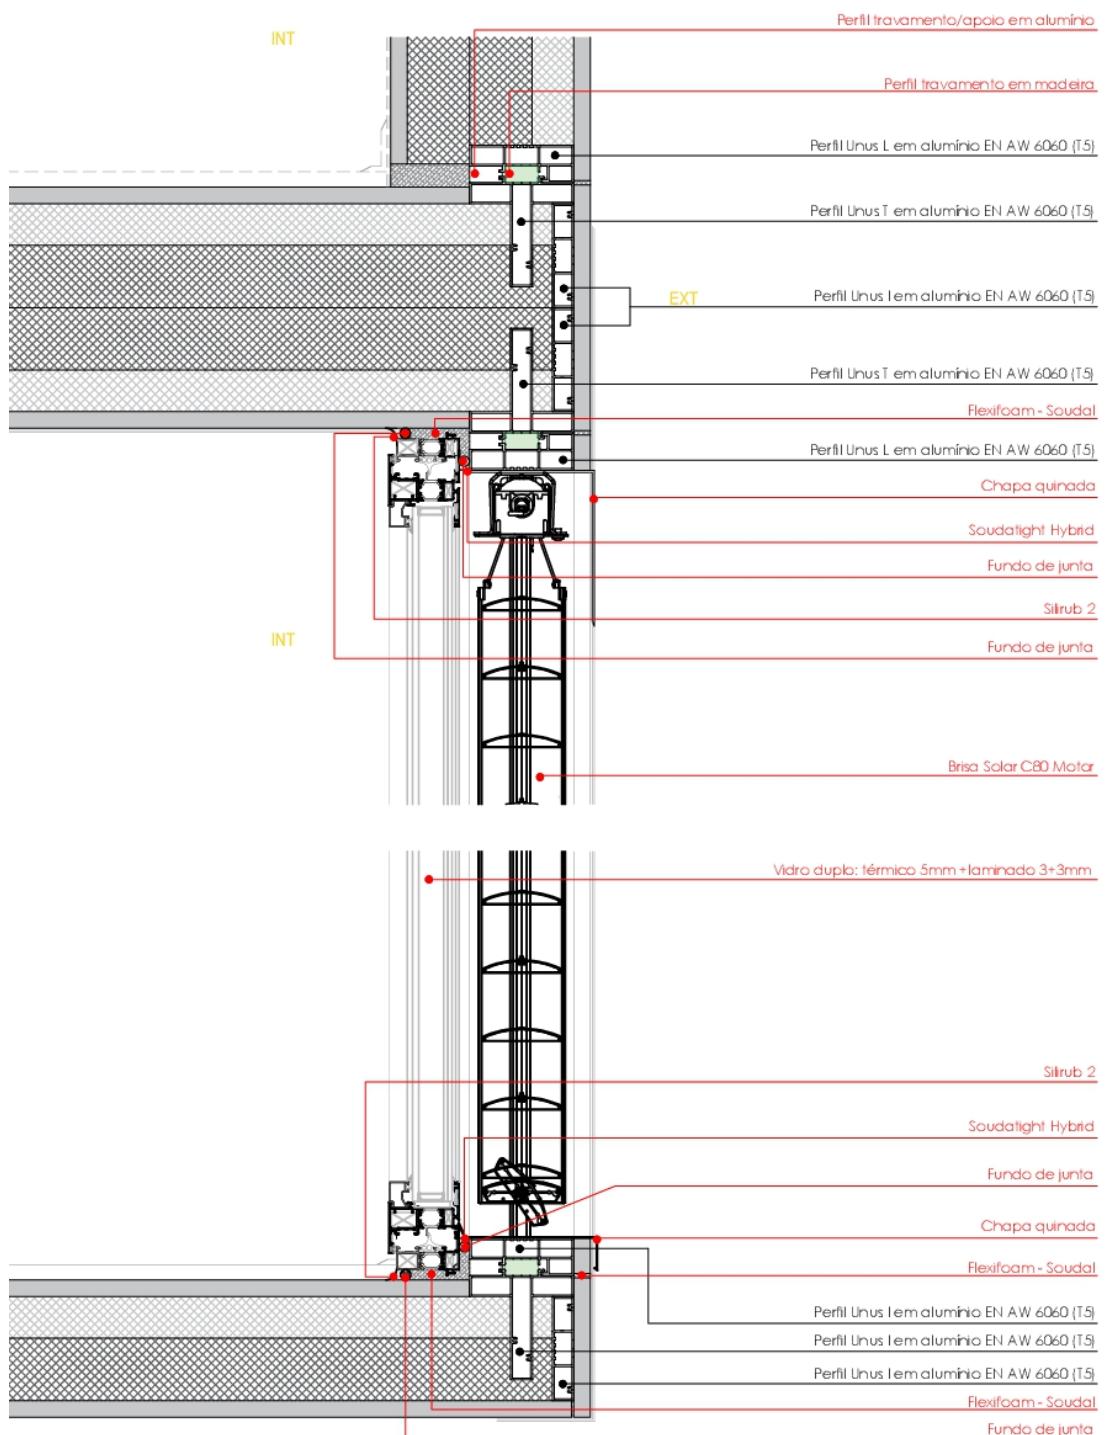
Solução AGEPAN – Pormenor Construtivo de Solução de Vão Exteriores.
